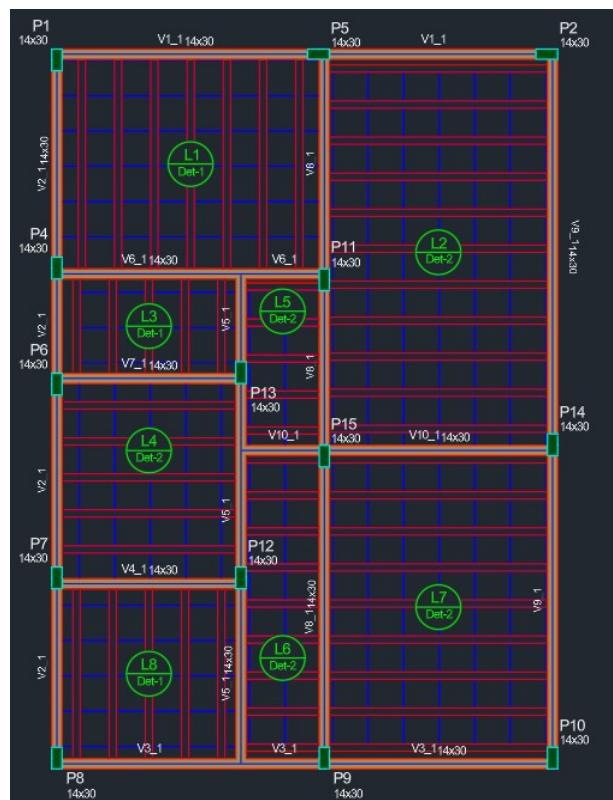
Modulação do edifício em concreto armado. (Fonte: Próprio Autor).
